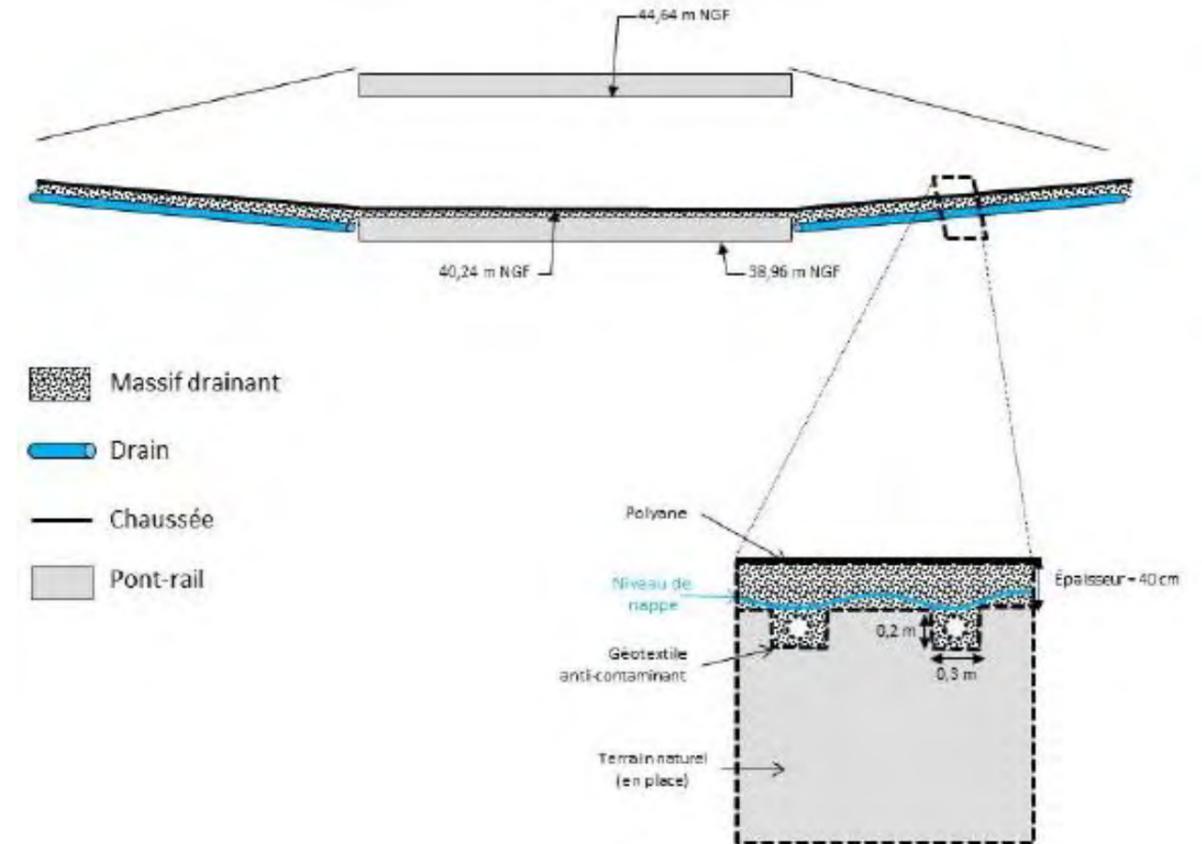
Coupe longitudinale de principe du dispositif de drainage mis en place sur le pont rail (source : BURGEAP pour SNCF Réseau, Etude hydrogéologique, Janvier 2018)
